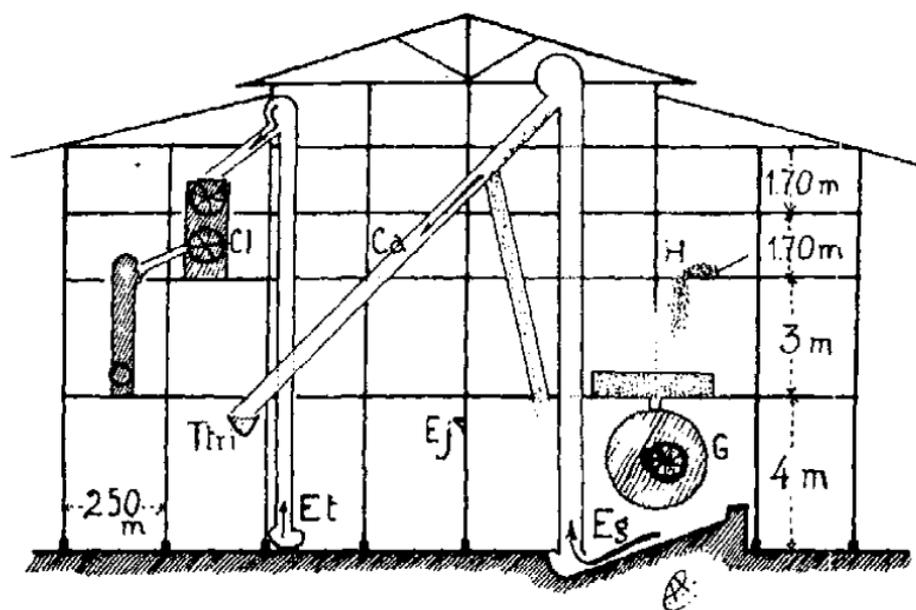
Tercer tipo de instalación: alzada. Ca, canal de descenso hacia la trilladora desde el elevador de la guardiola; Cl, clasificadora; Ej, eje de transmisión; Eg, elevador de la guardiola; Et, elevador de trillado; G, guardiola u Okrassa; H, hoyo para descargar el café de un piso a otro; Ttri, tolva de la trilladora. El café circula así en el edificio: tolva de la descerezadora, tanques de fermentación, lavadora, escurridor, elevador de húmedo, cajones de la guardiola, elevador de la guardiola que o lo lleva inmediatamente a la trilladora o por un canal que aparece en la figura, lo descarga en el depósito de café de trilla para tomarlo de nuevo cuando sea tiempo de trillarlo. Después seguirá este camino: trilladora, elevador de la trilladora, clasificador, catador, cuarto de enpaques.
